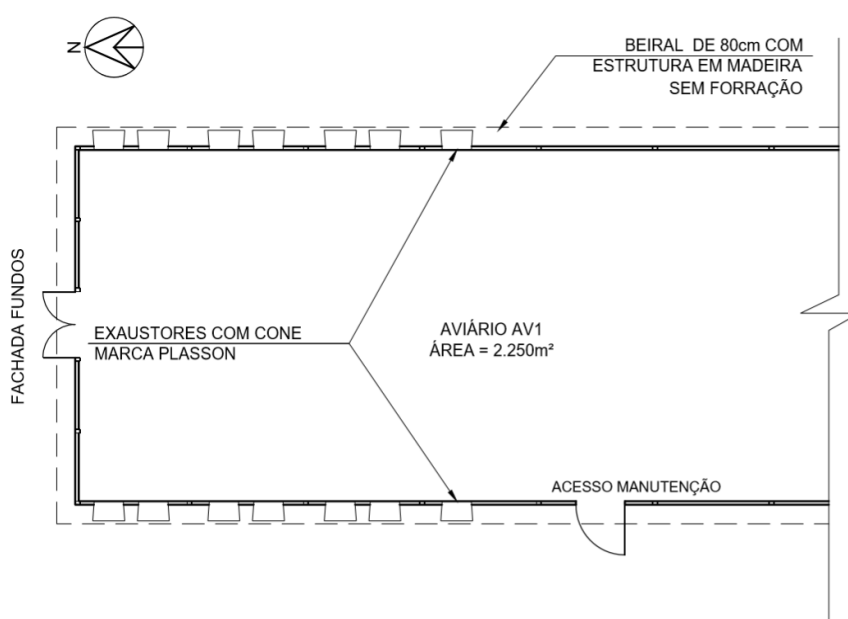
Planta baixa com a localização do sistema de ventilação - exaustores.
